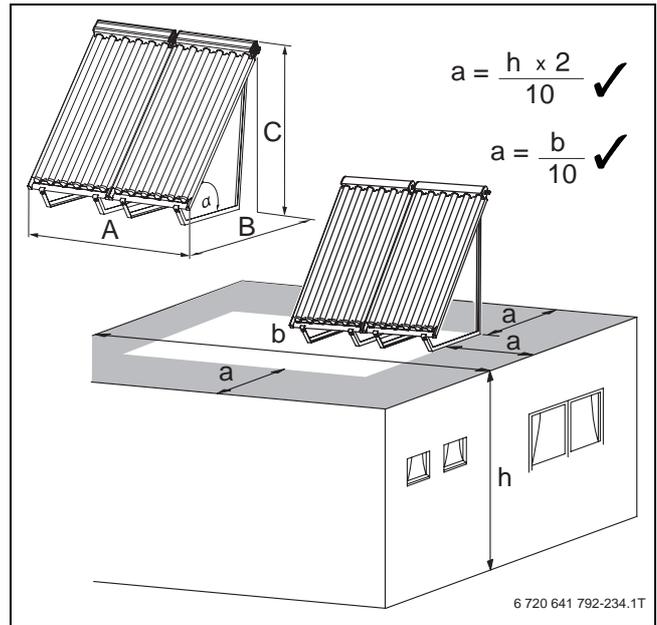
Distanza minima dal perimetro del tetto (misura a); applicare una formula (possibili entrambe)
